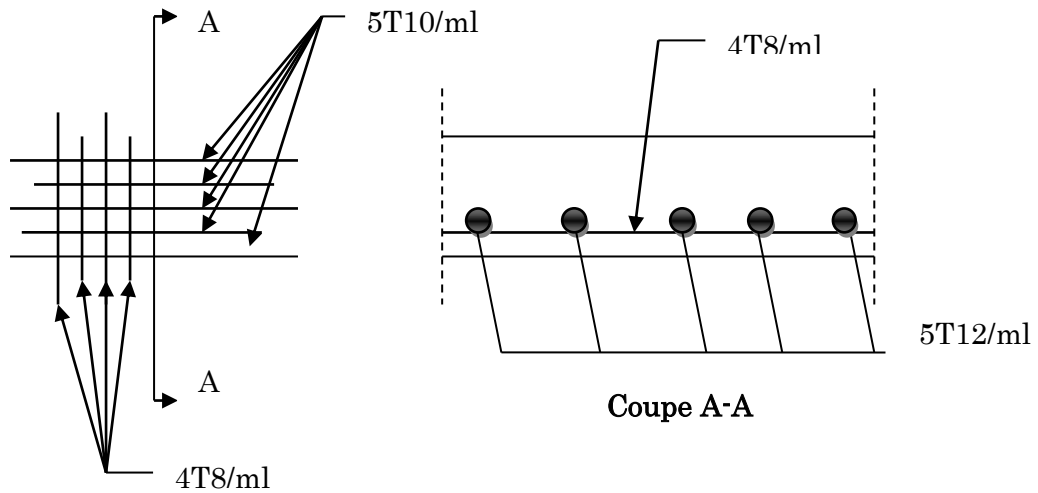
Schéma de ferrailage de la dalle sur trois appuis
